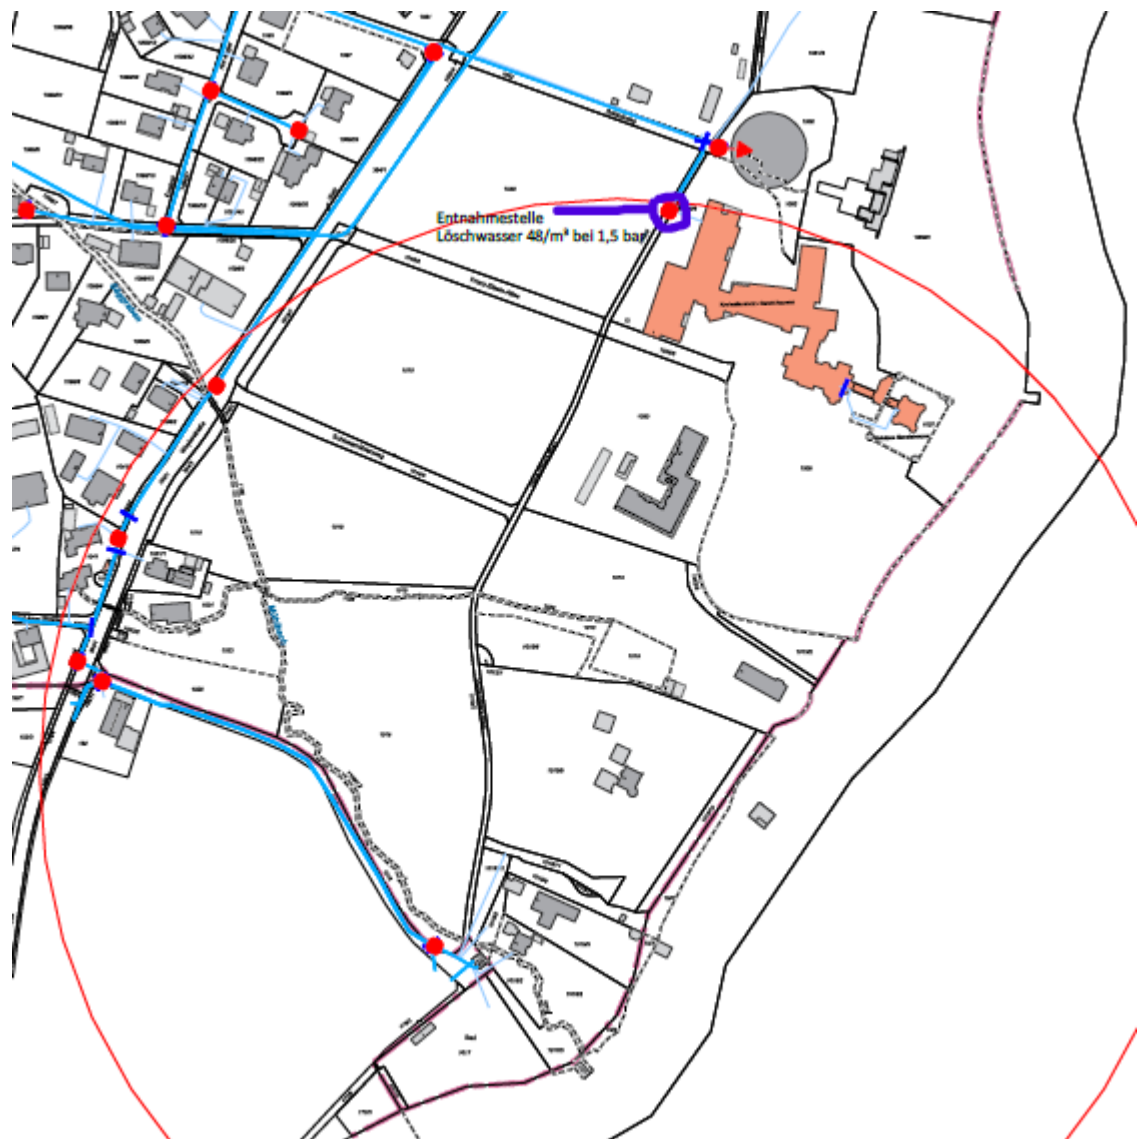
Löschwassernachweis, Brandschutznachweis, Brandschutztechnische Bewertung einer Gebäudeplanung in Bayern, Brandschutz Engel, 26.07.2024
